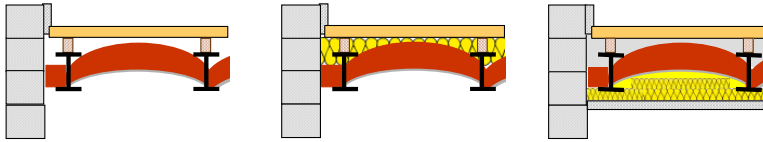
Stahlträger-Kappendecken
